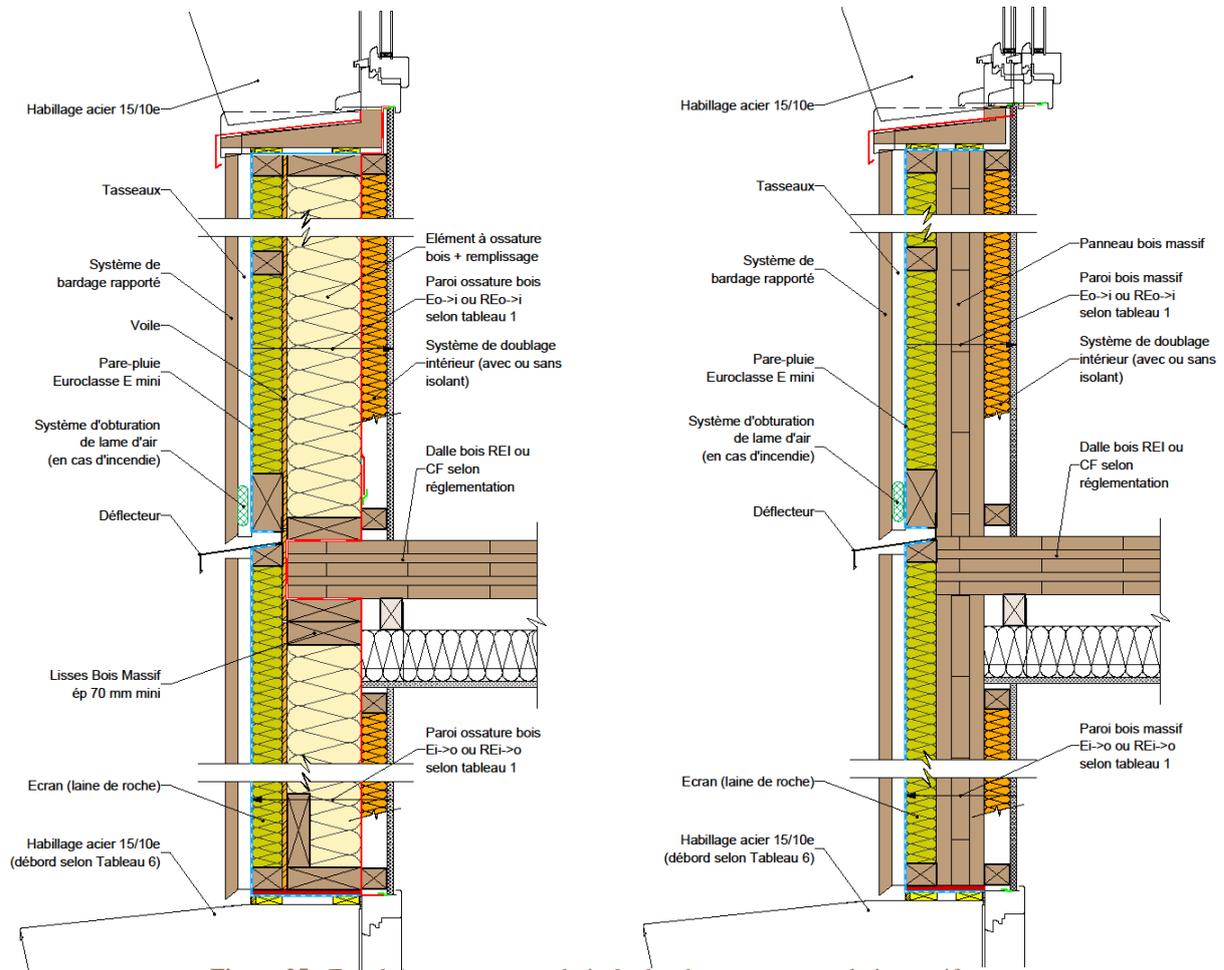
Façade/mur en ossature bois & plancher en panneaux bois massif.
